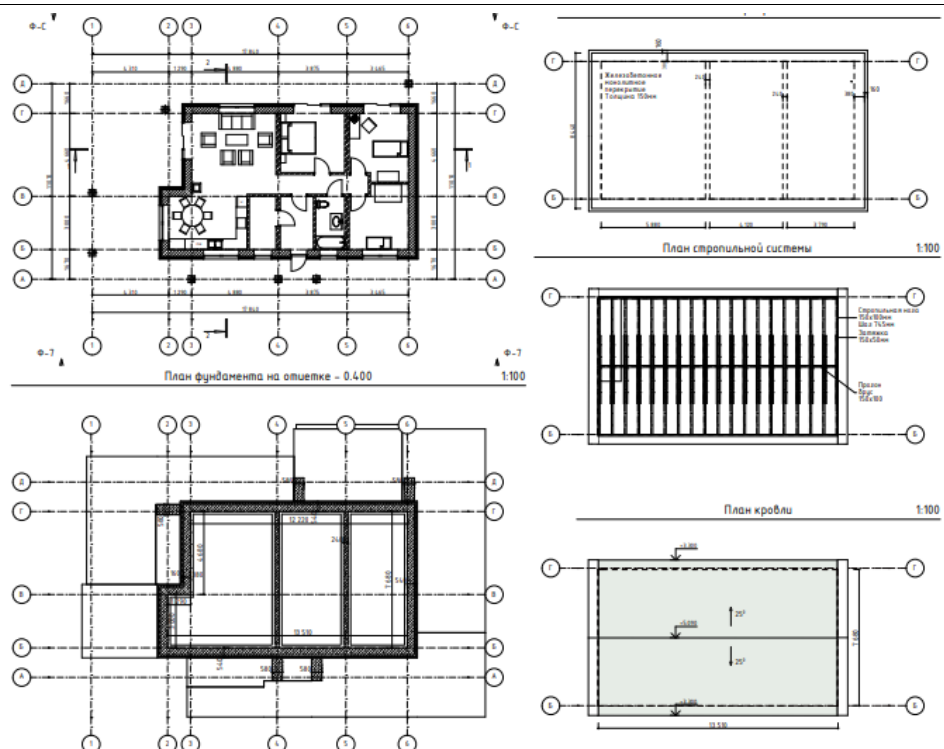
Основные планы здания: план фундамента, план кровли, план стропильной системы, план перекрытий
